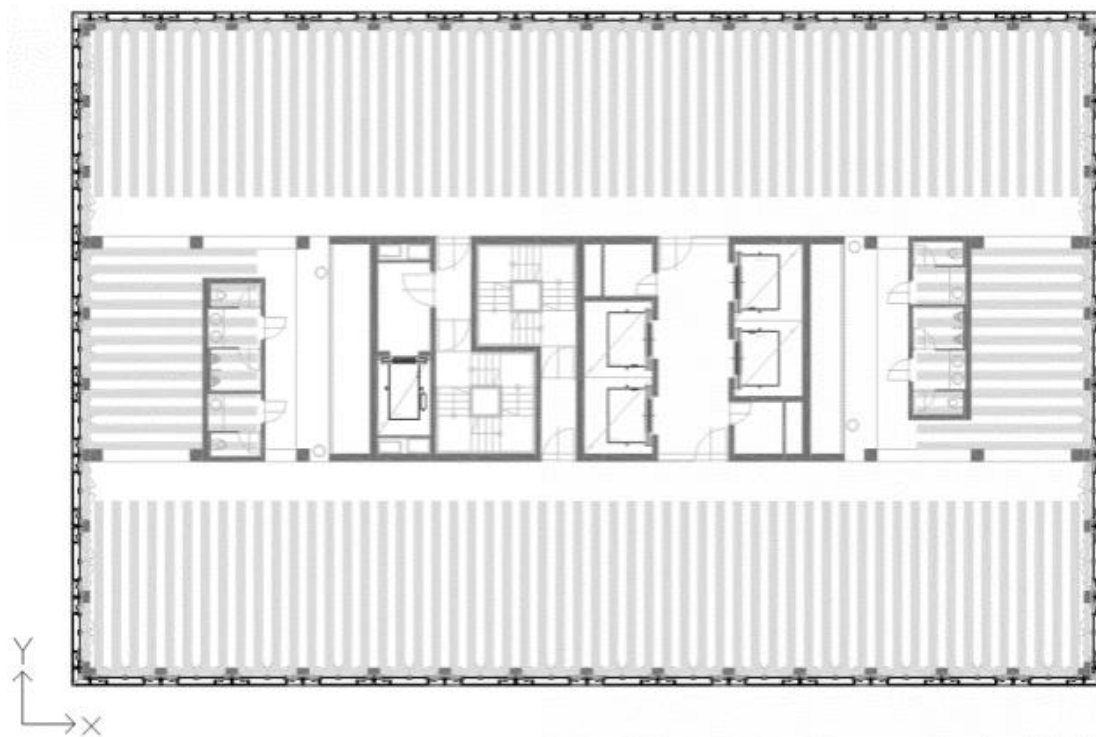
Schematischer Grundriss des LifeCycleTowers
